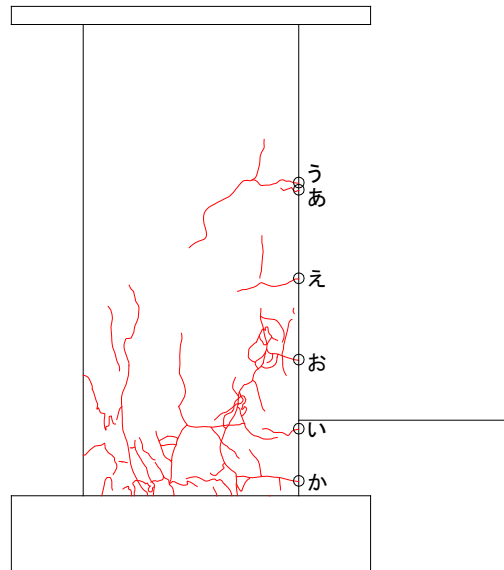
柱ひび割れ幅測定位置(試験体 A-4 負荷荷)
